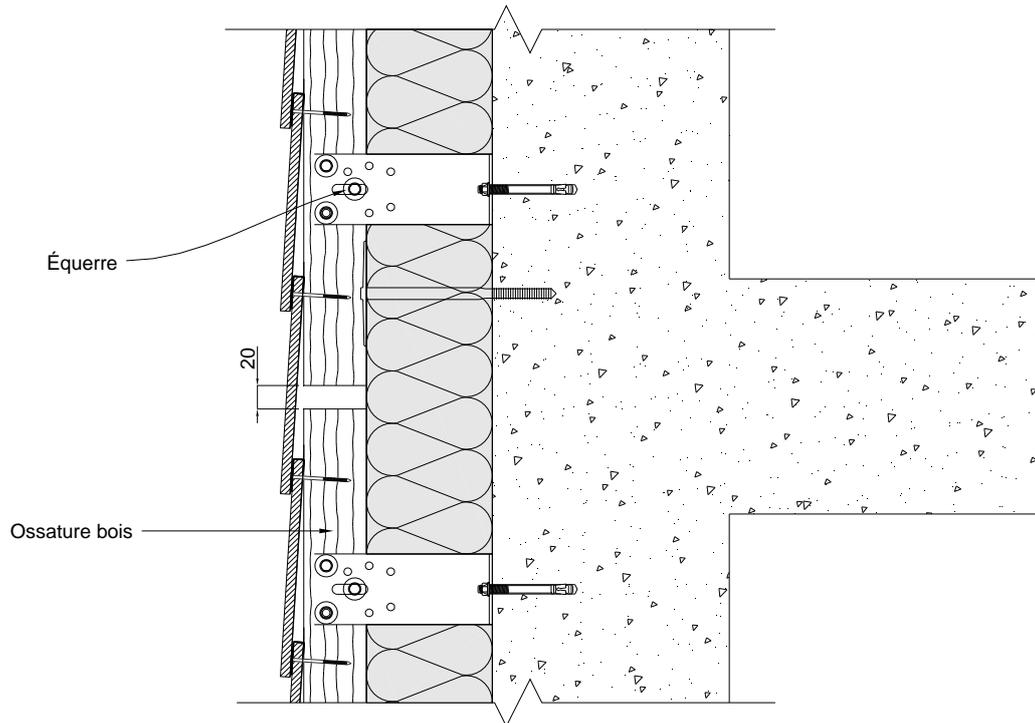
Joint de fractionnement au droit de chaque plancher – Pose horizontale
